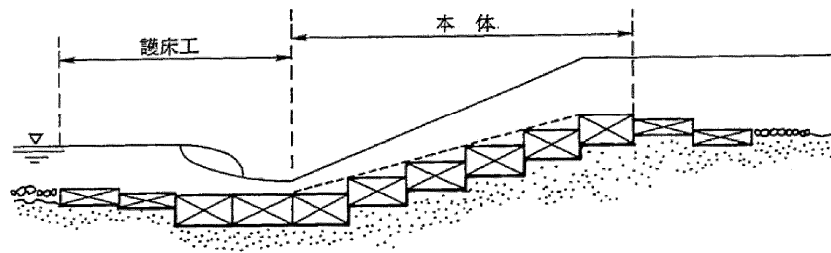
(2) コンクリート構造（緩傾斜型）概念図
